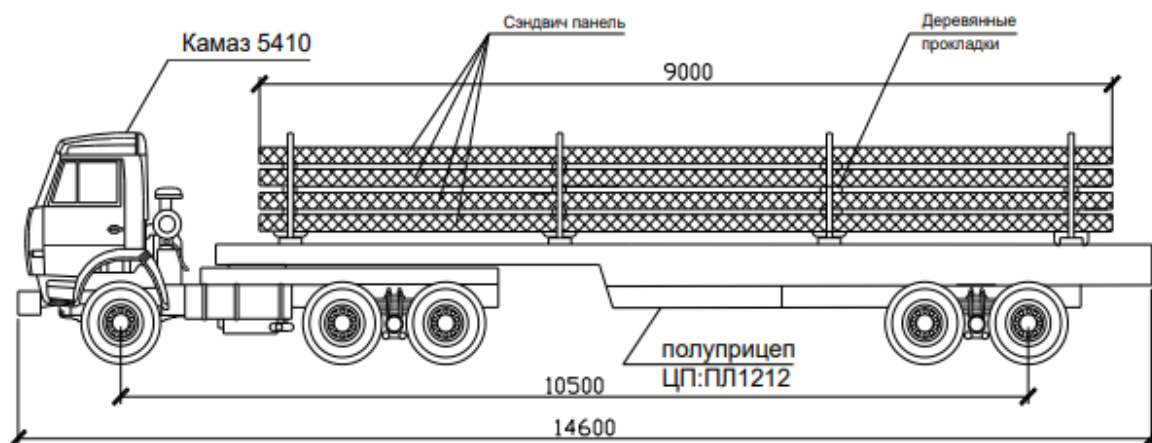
Схема перевозки стеновых и кровельных сэндвич панелей.
